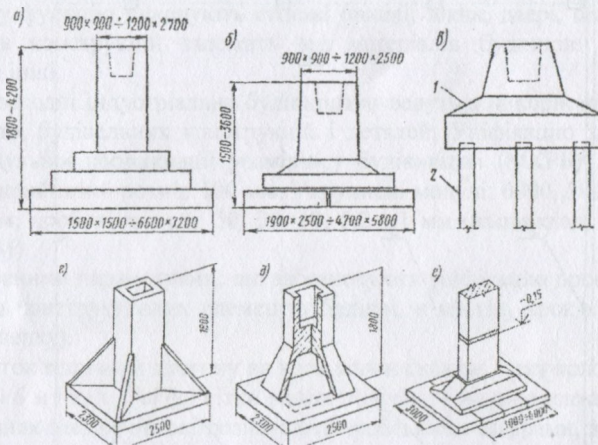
Види промислових фундаментів: а – монолітний ; б – збірний; в – пальовий
